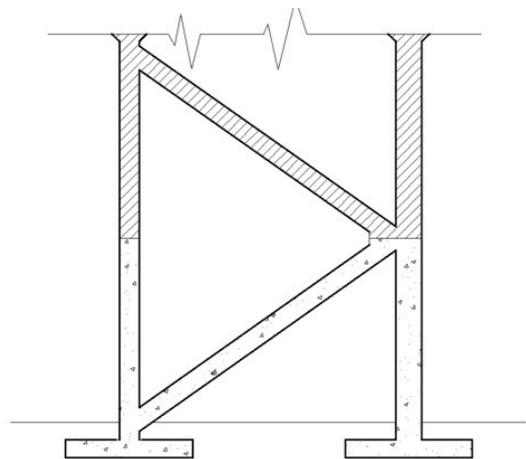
Betonagem da segunda fase (Contraventamentos em betão armado)
